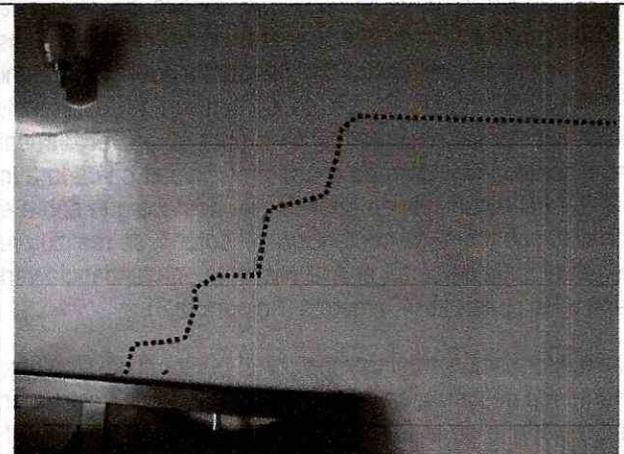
Fisuras típicas en los muros estructurales de las viviendas que se localizan en la zona central del bloque nororiental del Conjunto Residencial Cataluña.
